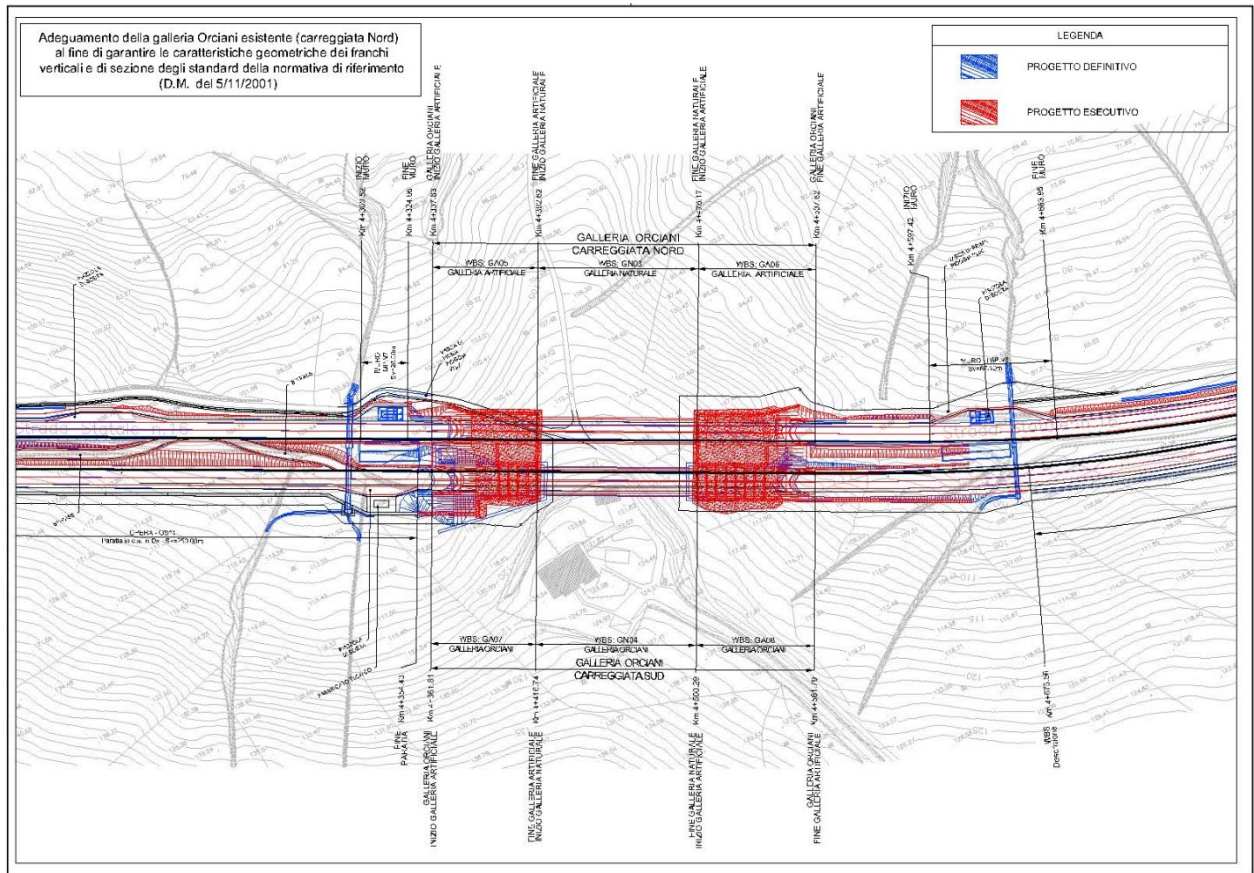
Sovrapposto planimetrico tra PD e PE nella zona Intervento 3 (galleria Orciani)
